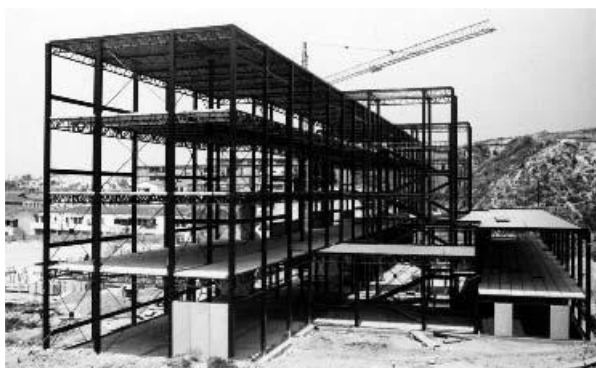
Casco estructural de una las escuelas con losas prefabricadas
